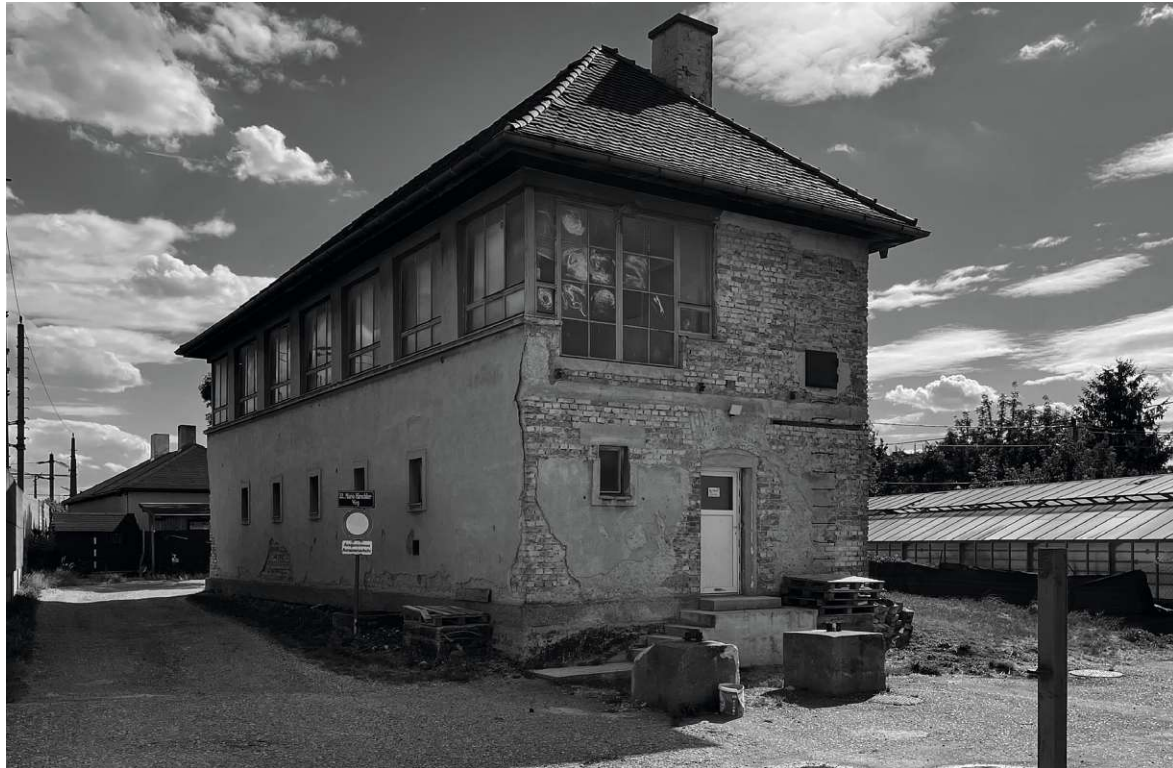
Befehl-Stellwerk Stadlau, Baujahr 1941 (2024)
